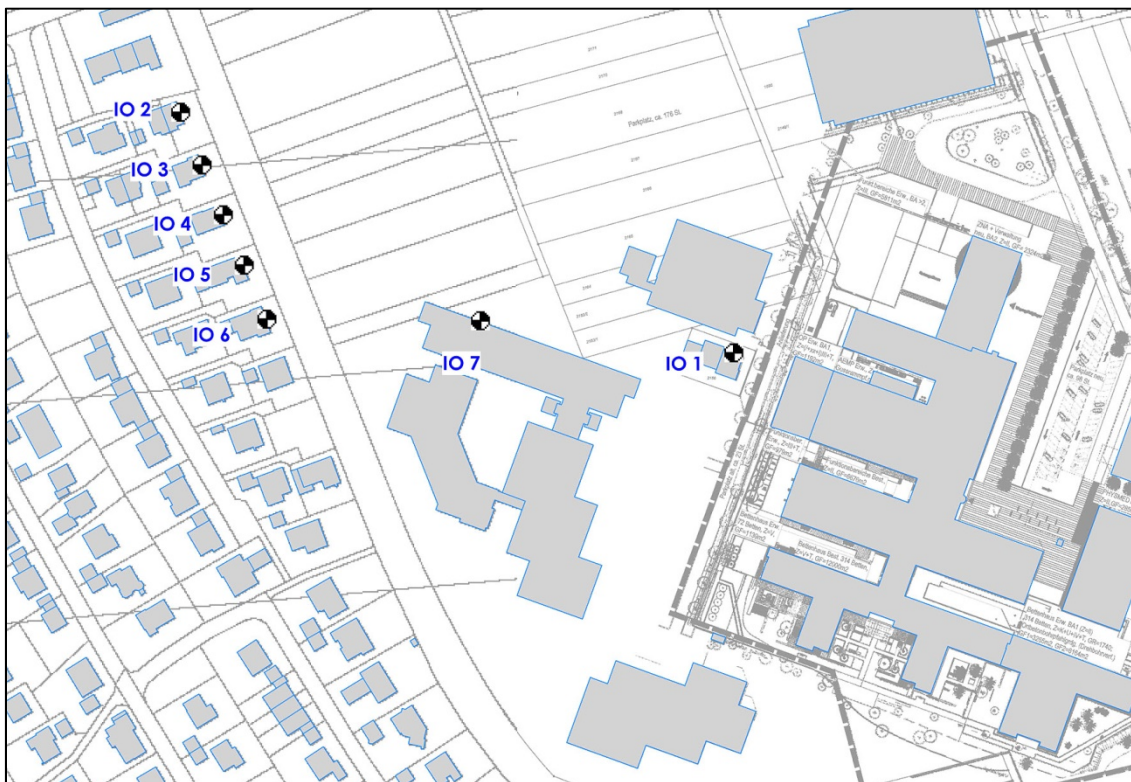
Lageplan mit Darstellung der maßgeblichen Immissionsorte IO
